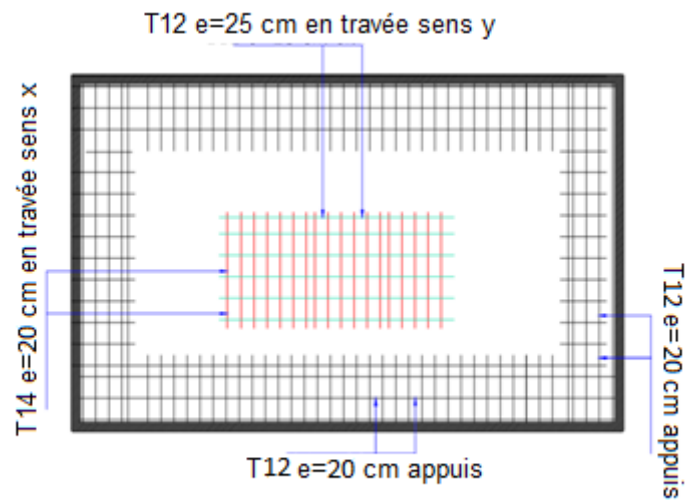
Ferrailage du voile périphérique Entre sol 1
